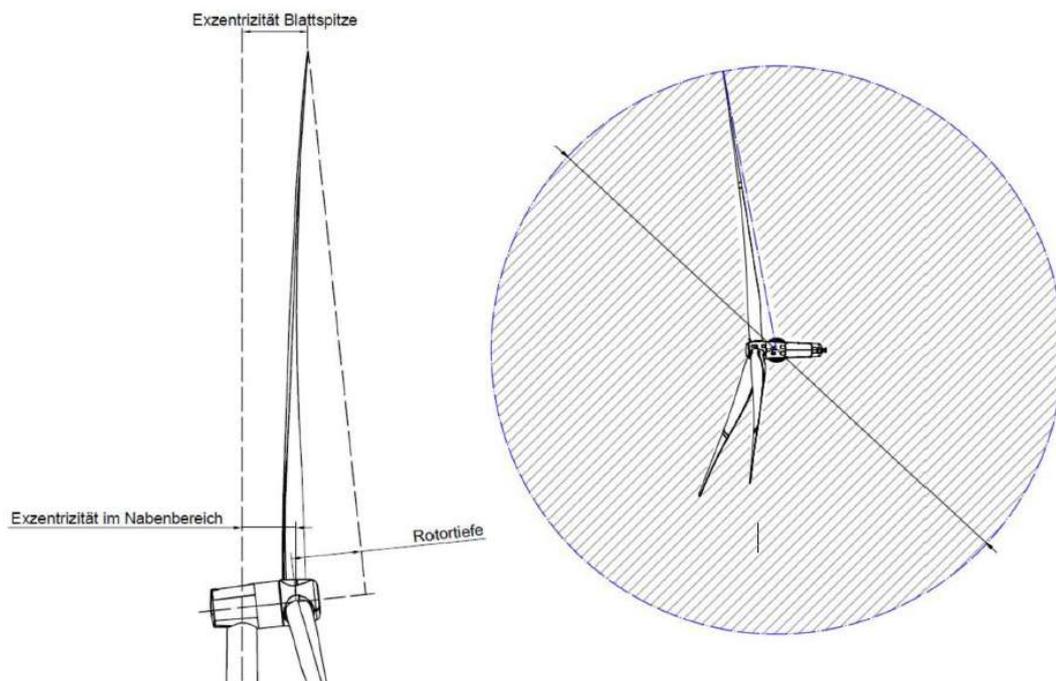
Grundrissplan Siemens SWT-DD-130 (Quelle: Siemens)
